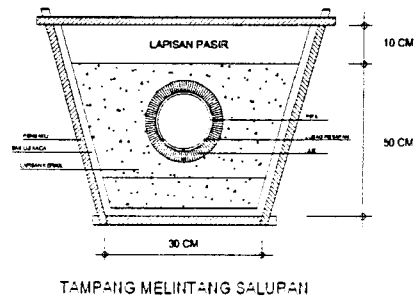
b Potongan melintang model pipa berporasi (resapan) tinggi
